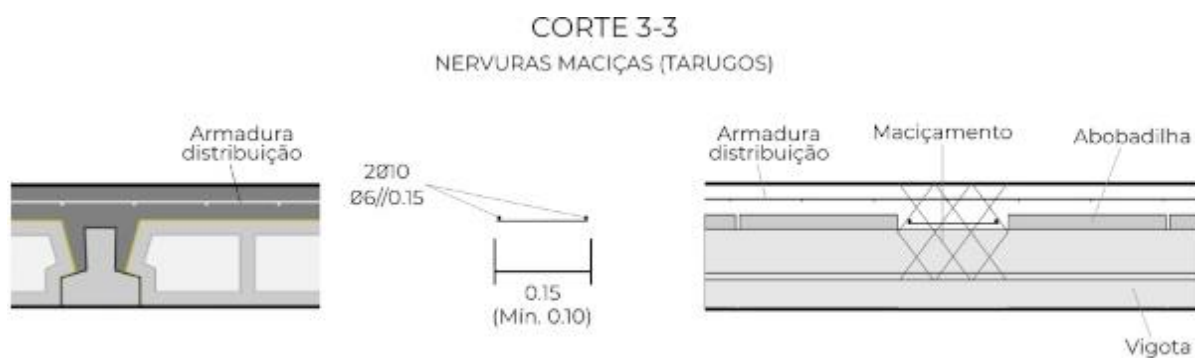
Nervuras transversais (Tarugos) em pavimentos com espessura total até 200 mm
